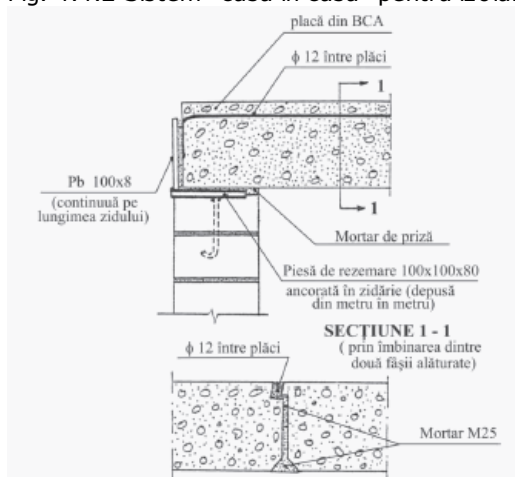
Detaliu de execuție planșeu (DETALIU A)
